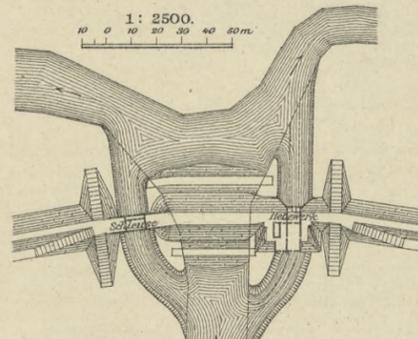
Schleuse und Hebewerk am Prudimfluss. Lageplan. 1: 2500.
